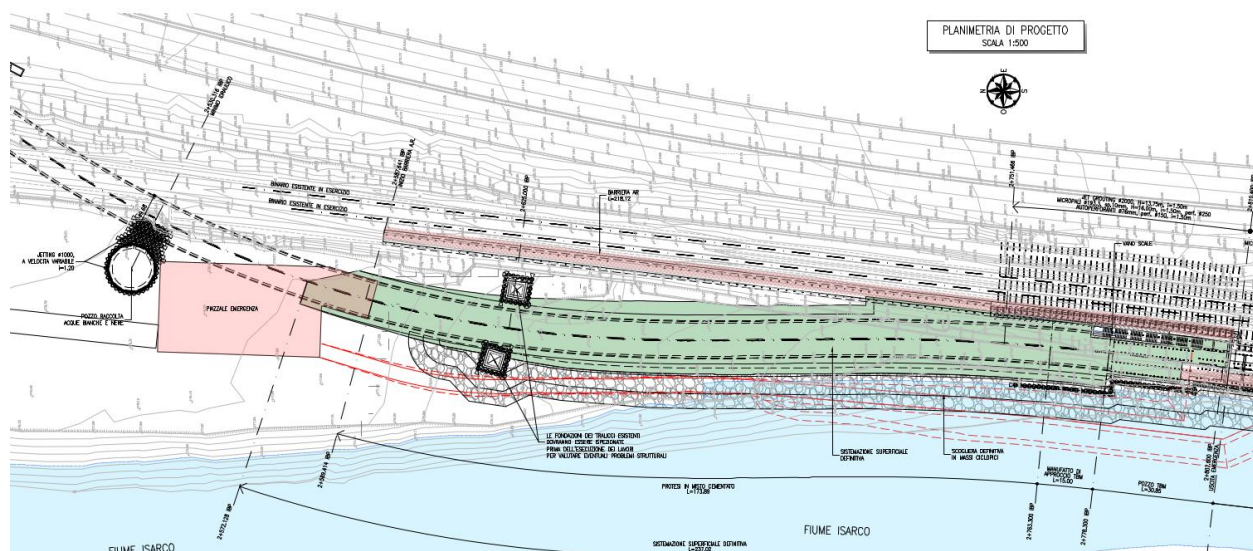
Planimetria dell’imbocco (Parte 2/2)
